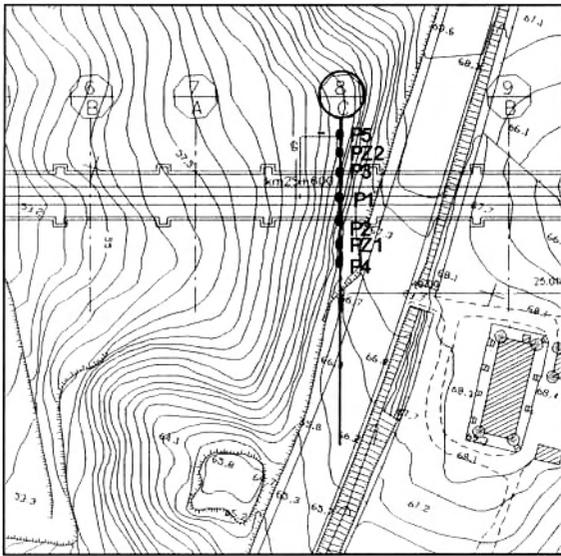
Exemplo da instrumentação de uma secção de tipo C (Planta).
